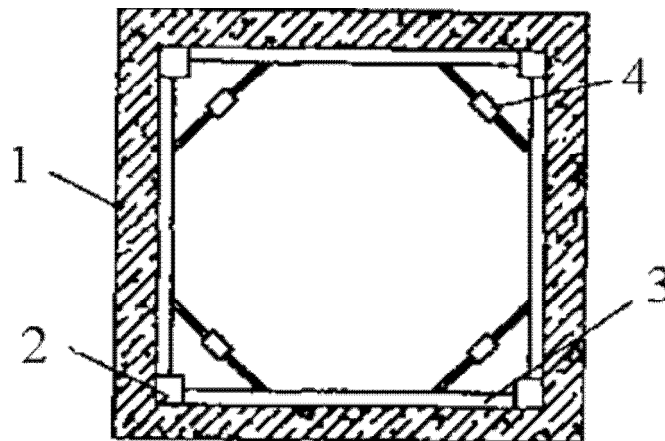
Об'ємно-блочна опалубка: 1 — бетонована конструкція; 2 — елемент каркасу опалубки; 3 — щит опалубки; 4 — стяжна муфта
